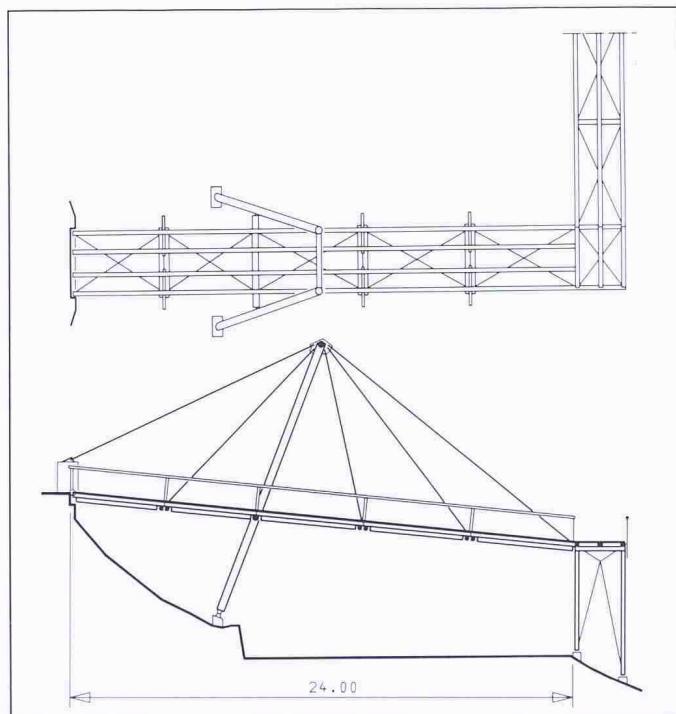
Grundriss und Längsschnitt des Stegs (mit Zugangsrampe rechts angeschnitten)
